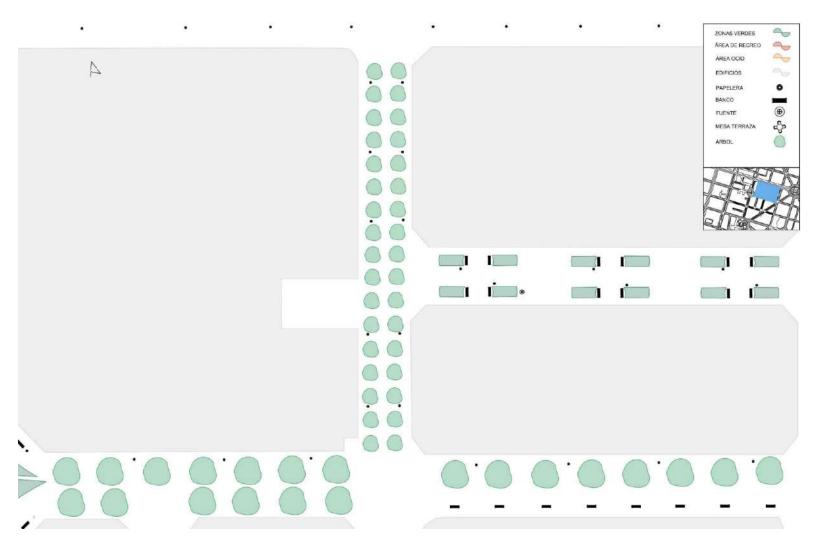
Plano de detalle 2. Escala 1:500 (A3)
